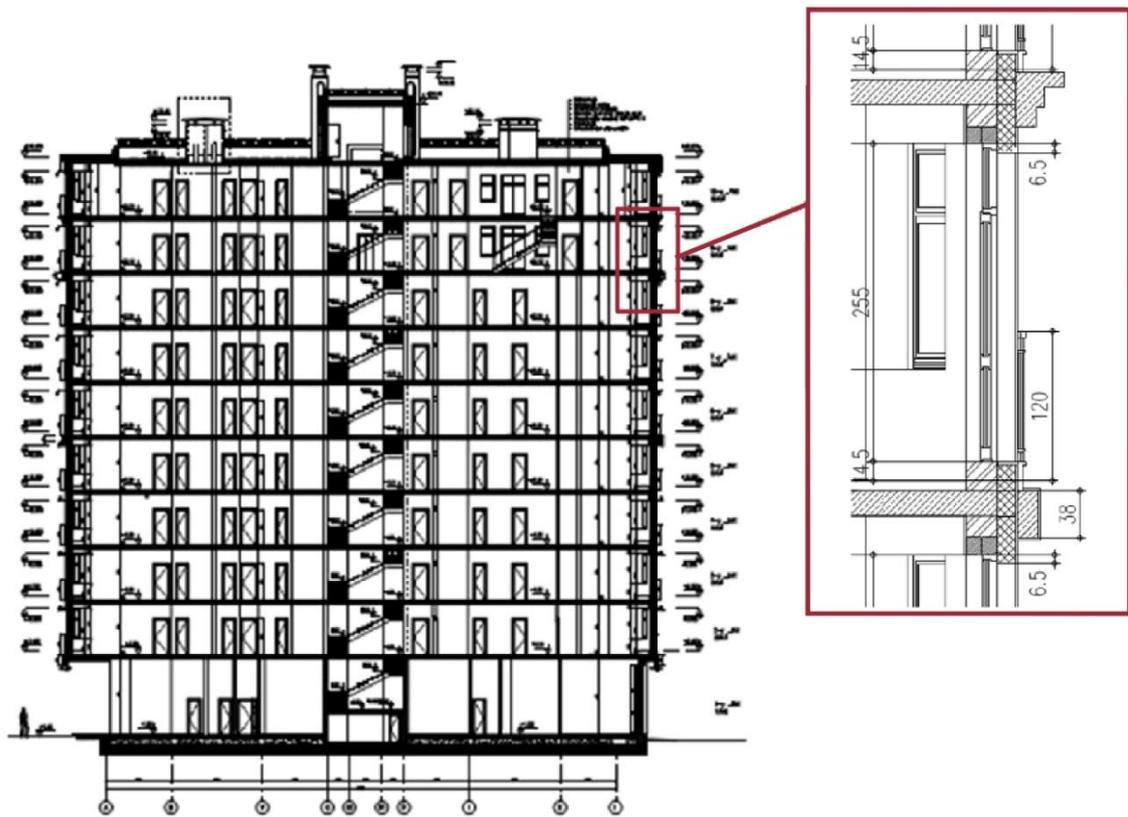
Разрез здания и штукатурный фасад по кирпичу
